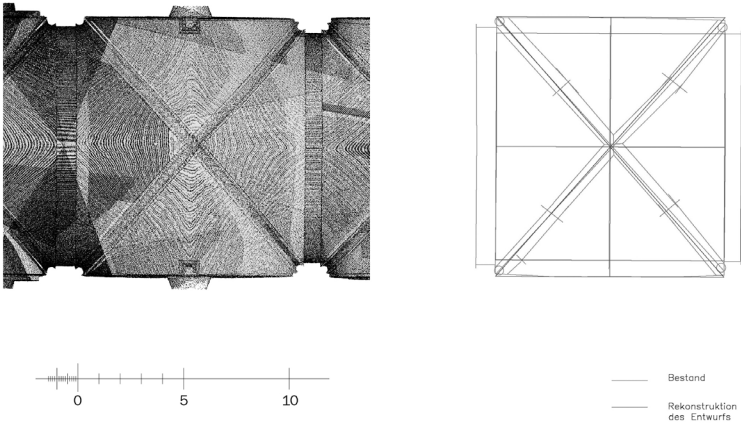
Bamberger Dom, Mittelschiff, 2. Joch von Osten. Grundrissprojektion der Gewölbe & Tatsächlicher Rippenverlauf und Rekonstruktion der Grundrissdisposition
